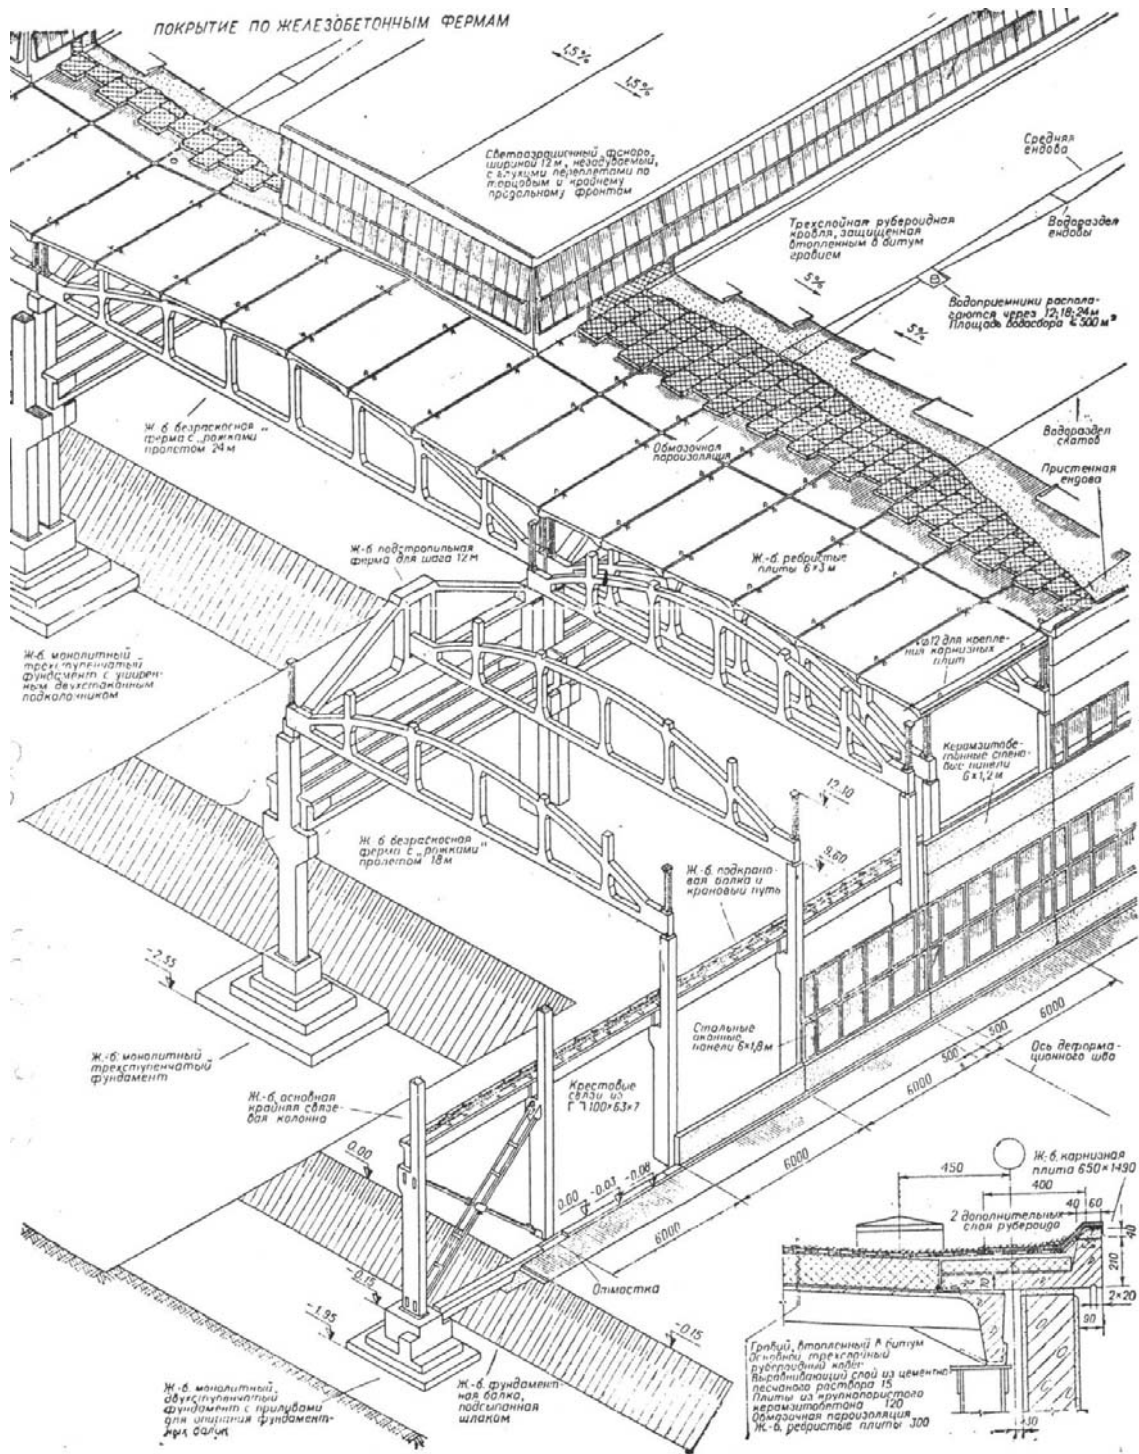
Конструкция промышленного здания с мостовыми кранами
